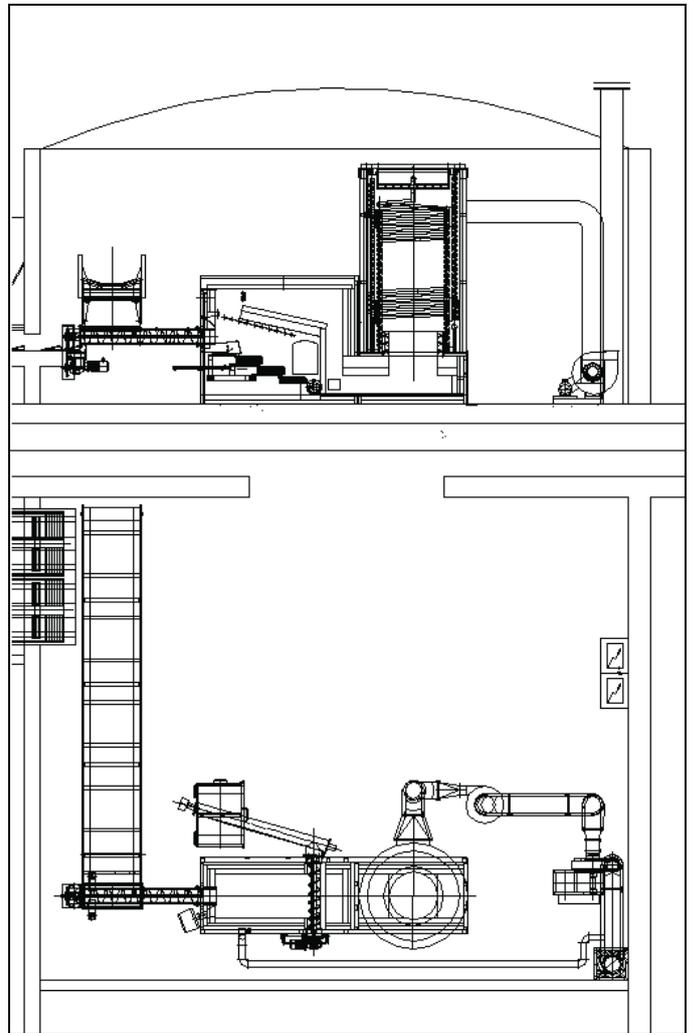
Pianta e sezione del locale centrale termica a biomasse
